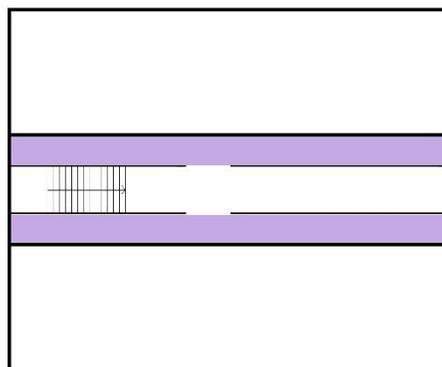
Lavandería común en piso. Fuente: Elaboración propia.
